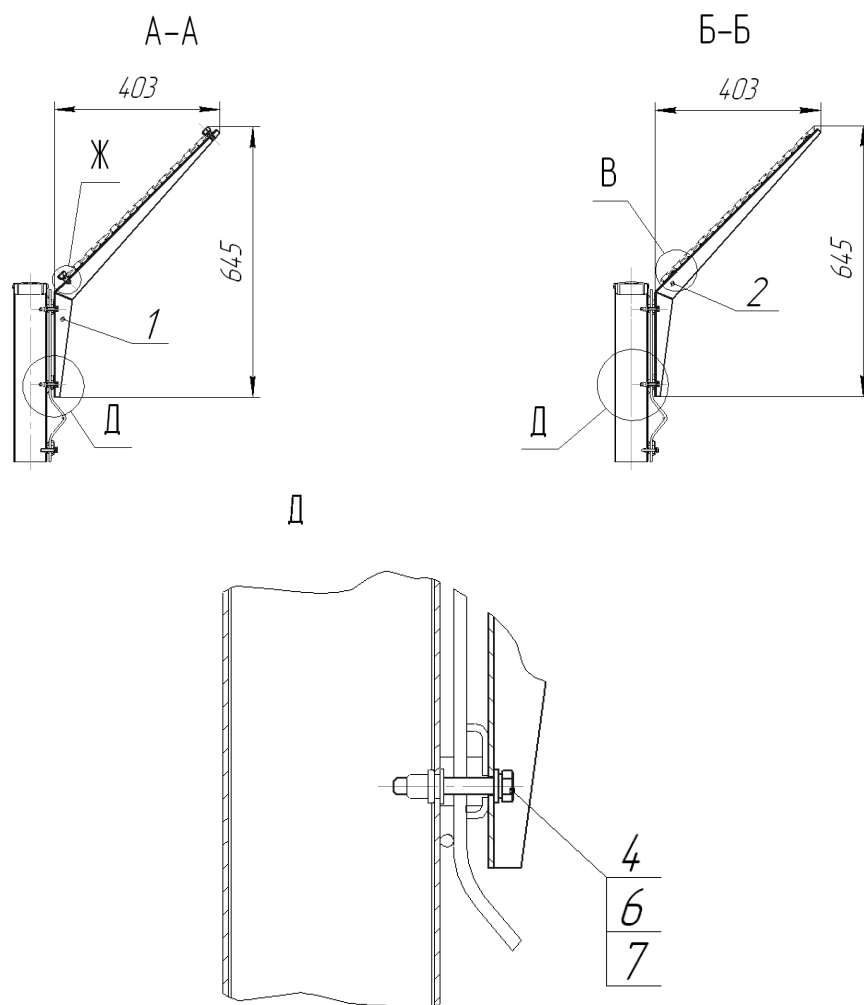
Разрезы А–А, Б–Б, детальный вид Д
